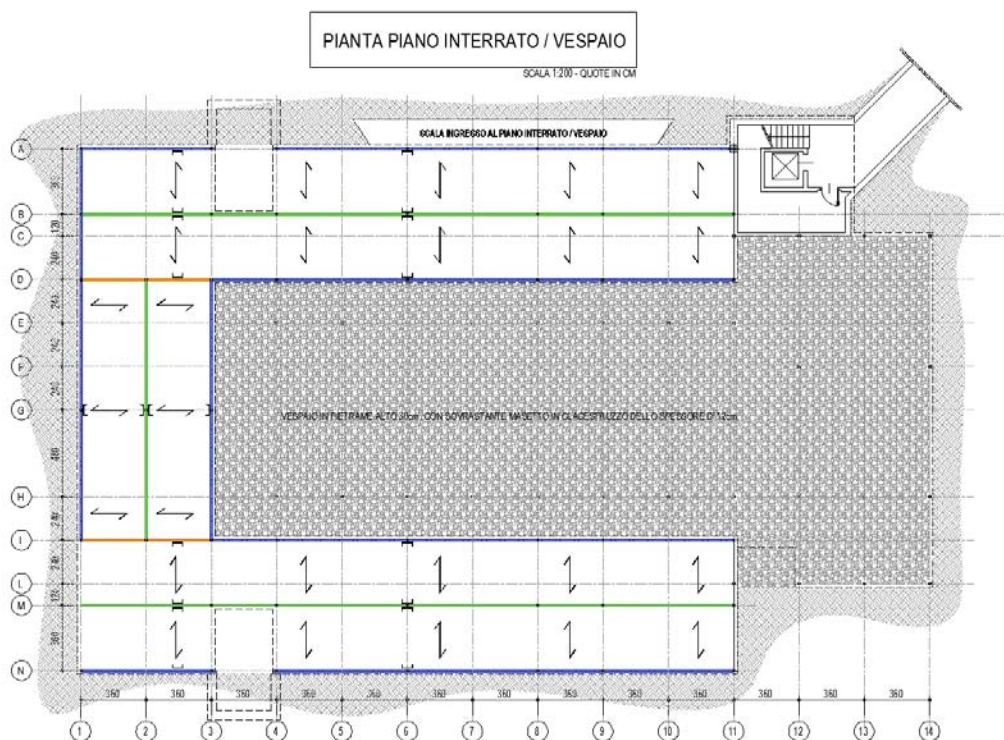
Pianta interventi di irrigidimento - interrato
